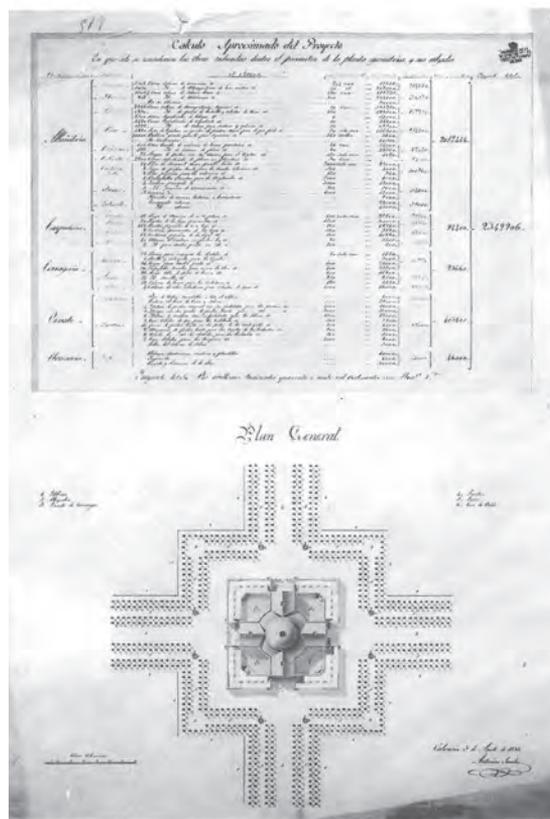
Proyecto. Planta aérea y cálculo aproximado del proyecto.
